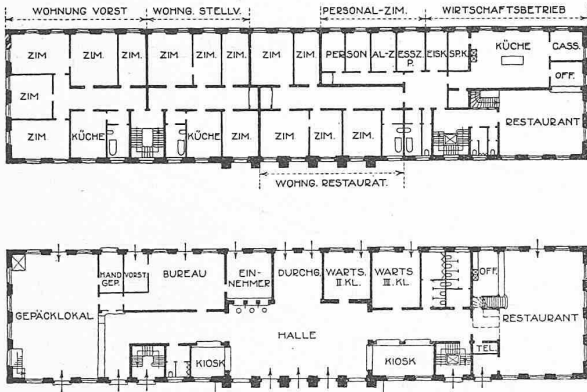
und 19. Grundrisse des Aufnahmegebäudes. — 1 : 800.
